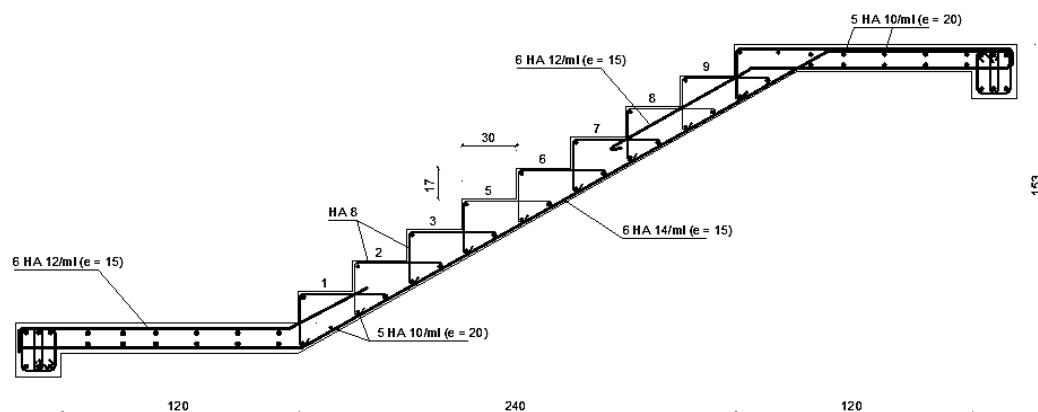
Schémas de ferrailage d'escaliers en béton ordinaire.
